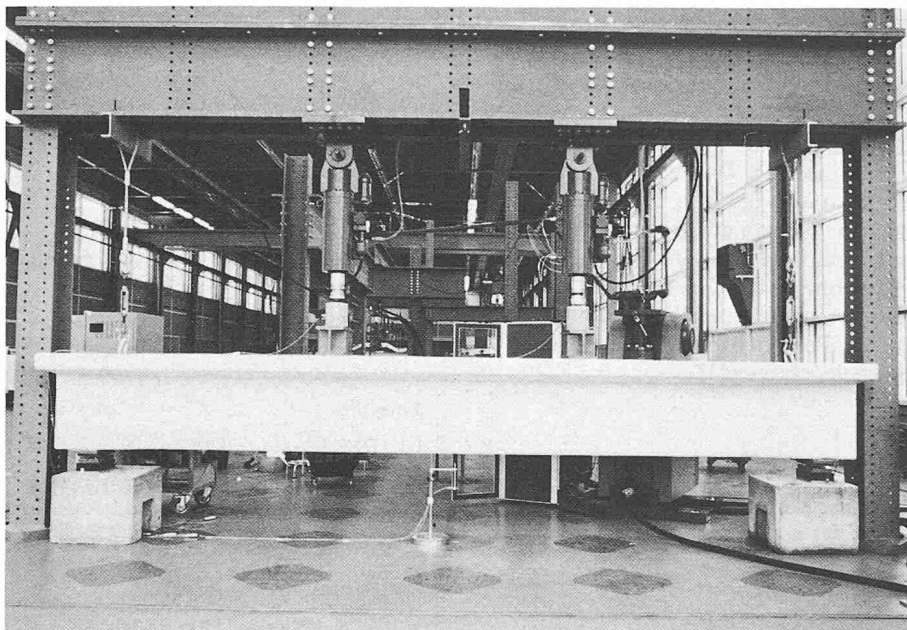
Ermüdungsversuch an einem teilweise vorgespannten Balken
